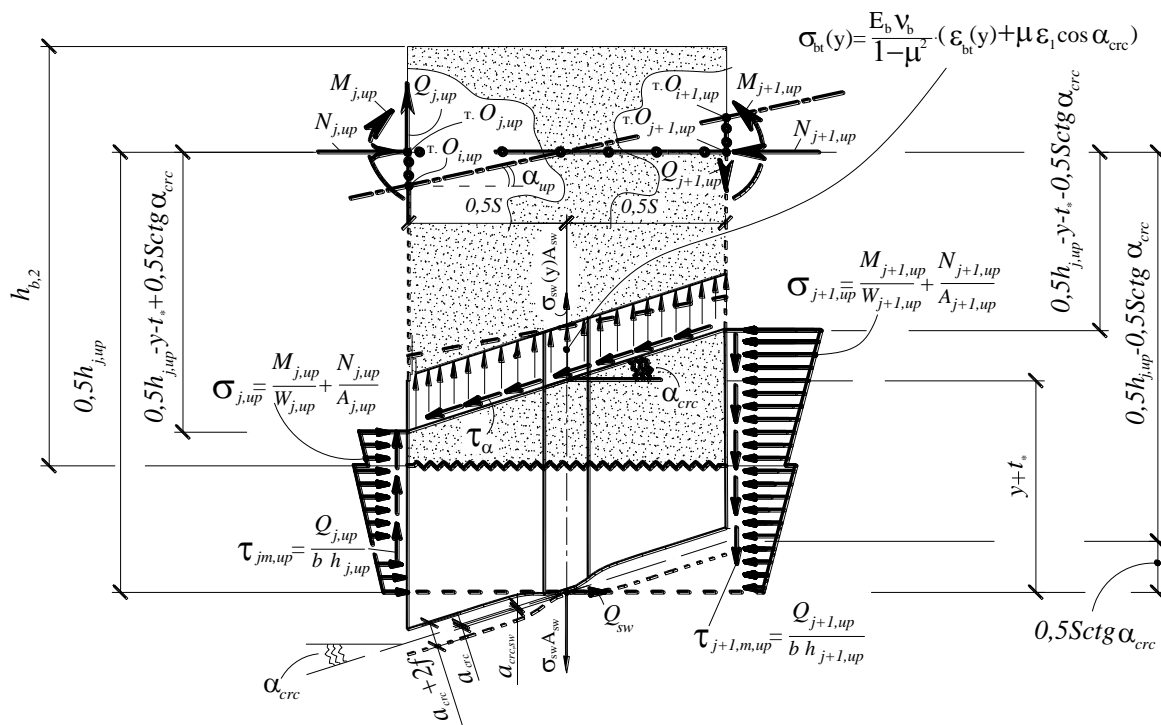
Расчетная схема к определению деформаций растянутого бетона $\varepsilon_{bt}(y)$ между наклонными трещинами третьего типа в железобетонной составной конструкции (случай 1)
